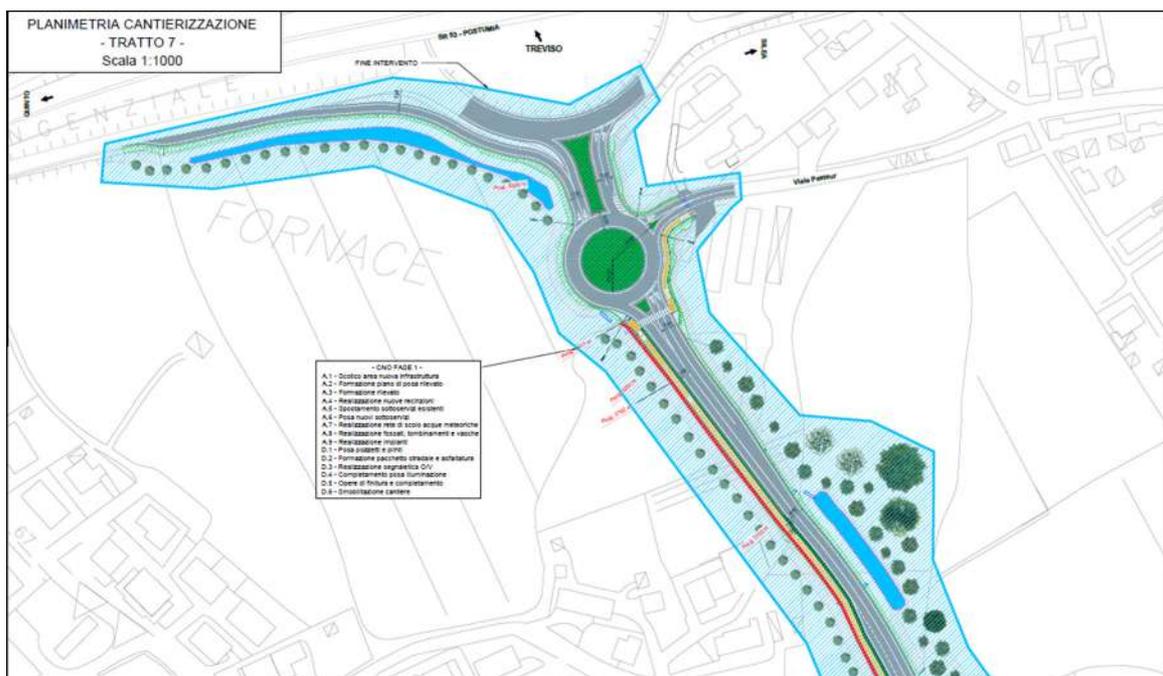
Particolare cantierizzazione collegamento alla tangenziale di Treviso
